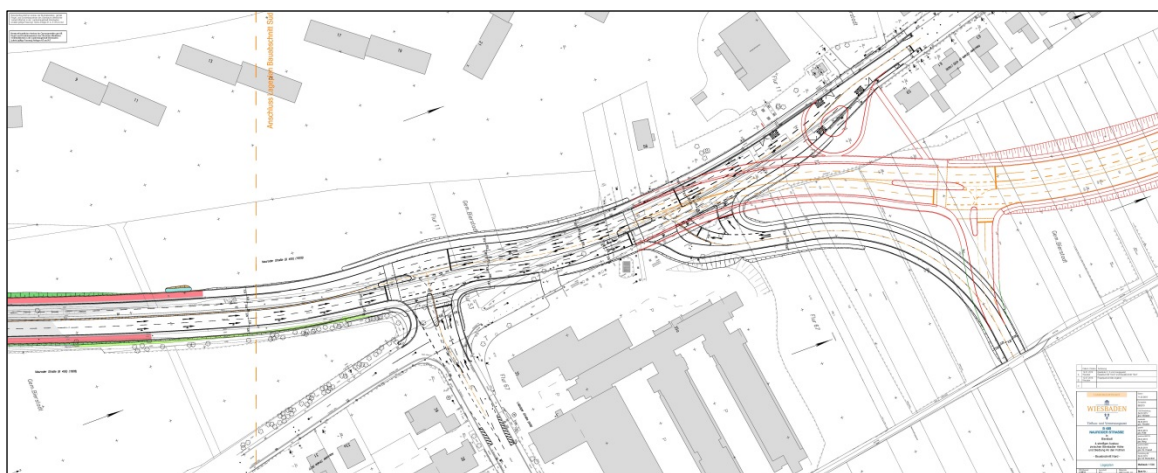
Lageplan BA1 Bauabschnitt Nord mit Option Umgehung Fichten
